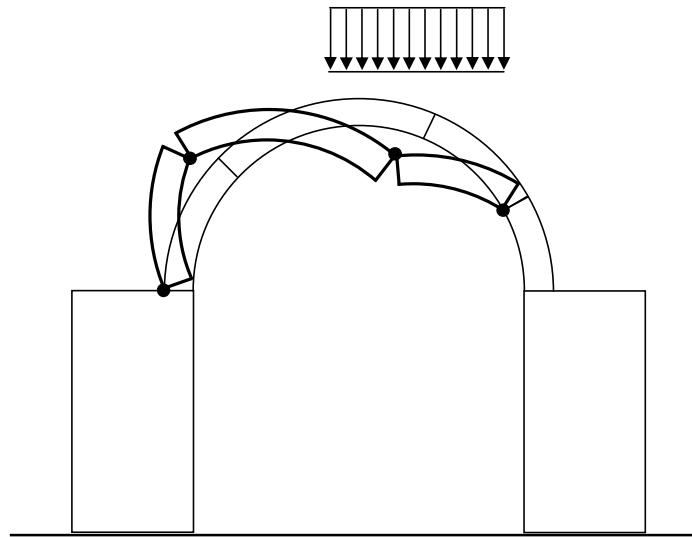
a. Meccanismo asimmetrico a imposte fisse: 4 cerniere alternate, estradosso-intradosso. La prima cerniera nel semi-arco meno caricato è estradosale e in genere è all'imposta.
